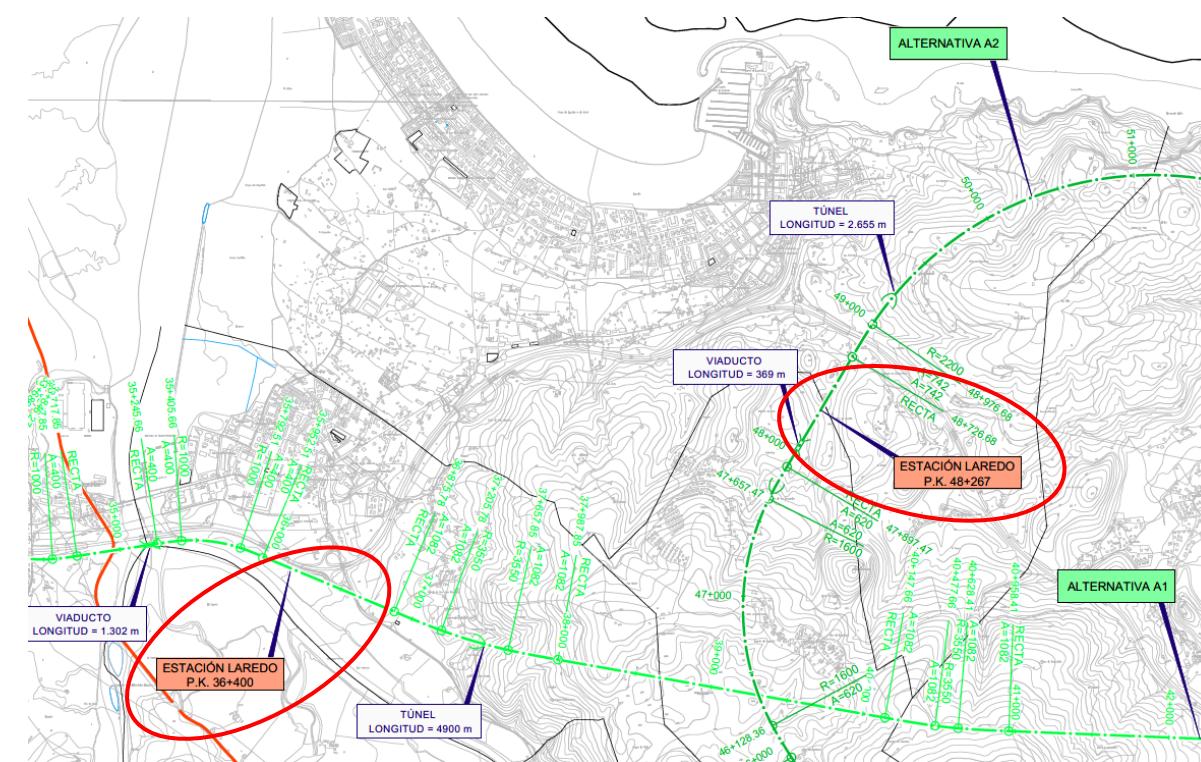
Estación Laredo en planta de Alternativa A1, A2 y A1 Modificada
